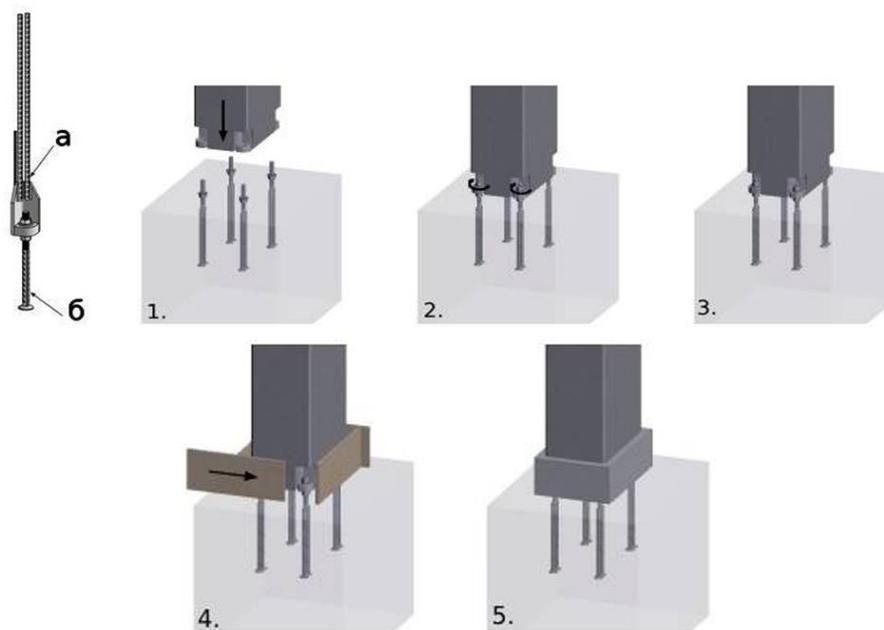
Узловое соединение ПЕС компании Peikko и стадии монтажа колонны с применением системы ПЕС: а – башмак колонны; б – анкерный болт; 1 – установка колонны на выверенные гайки; 2 – накручивание верхних гаек; 3 – затяжка верхних гаек; 4 – заливка базы колонны безусадочным раствором; 5 – готовое соединение
